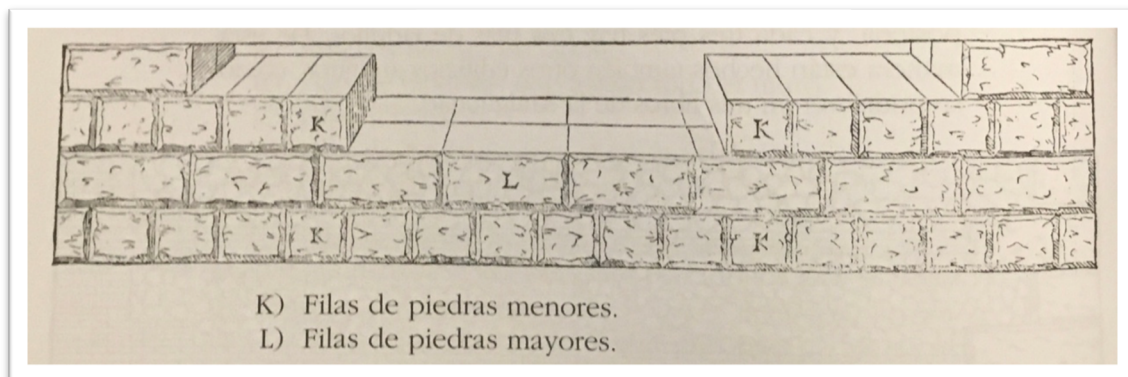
Sistema constructivo para muros de mampostería con piedras cuadradas
